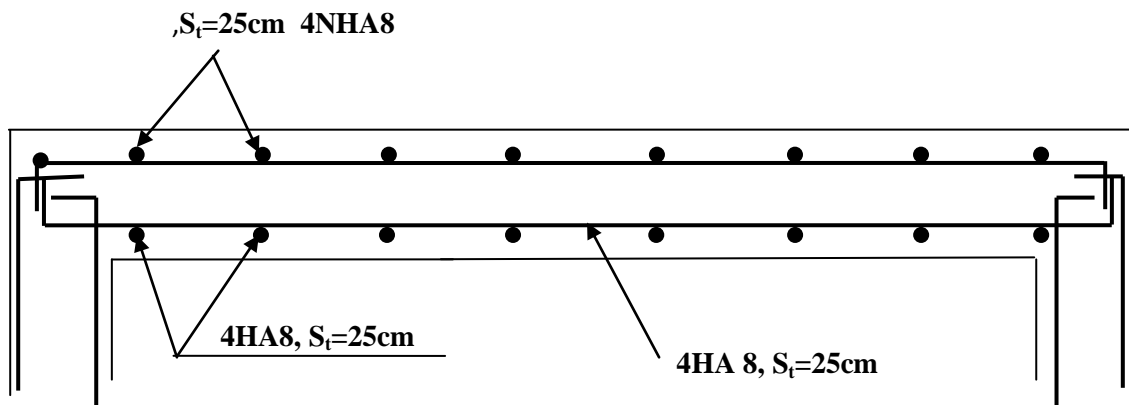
Plan de ferrailage de la salle machine suivant y-y.
